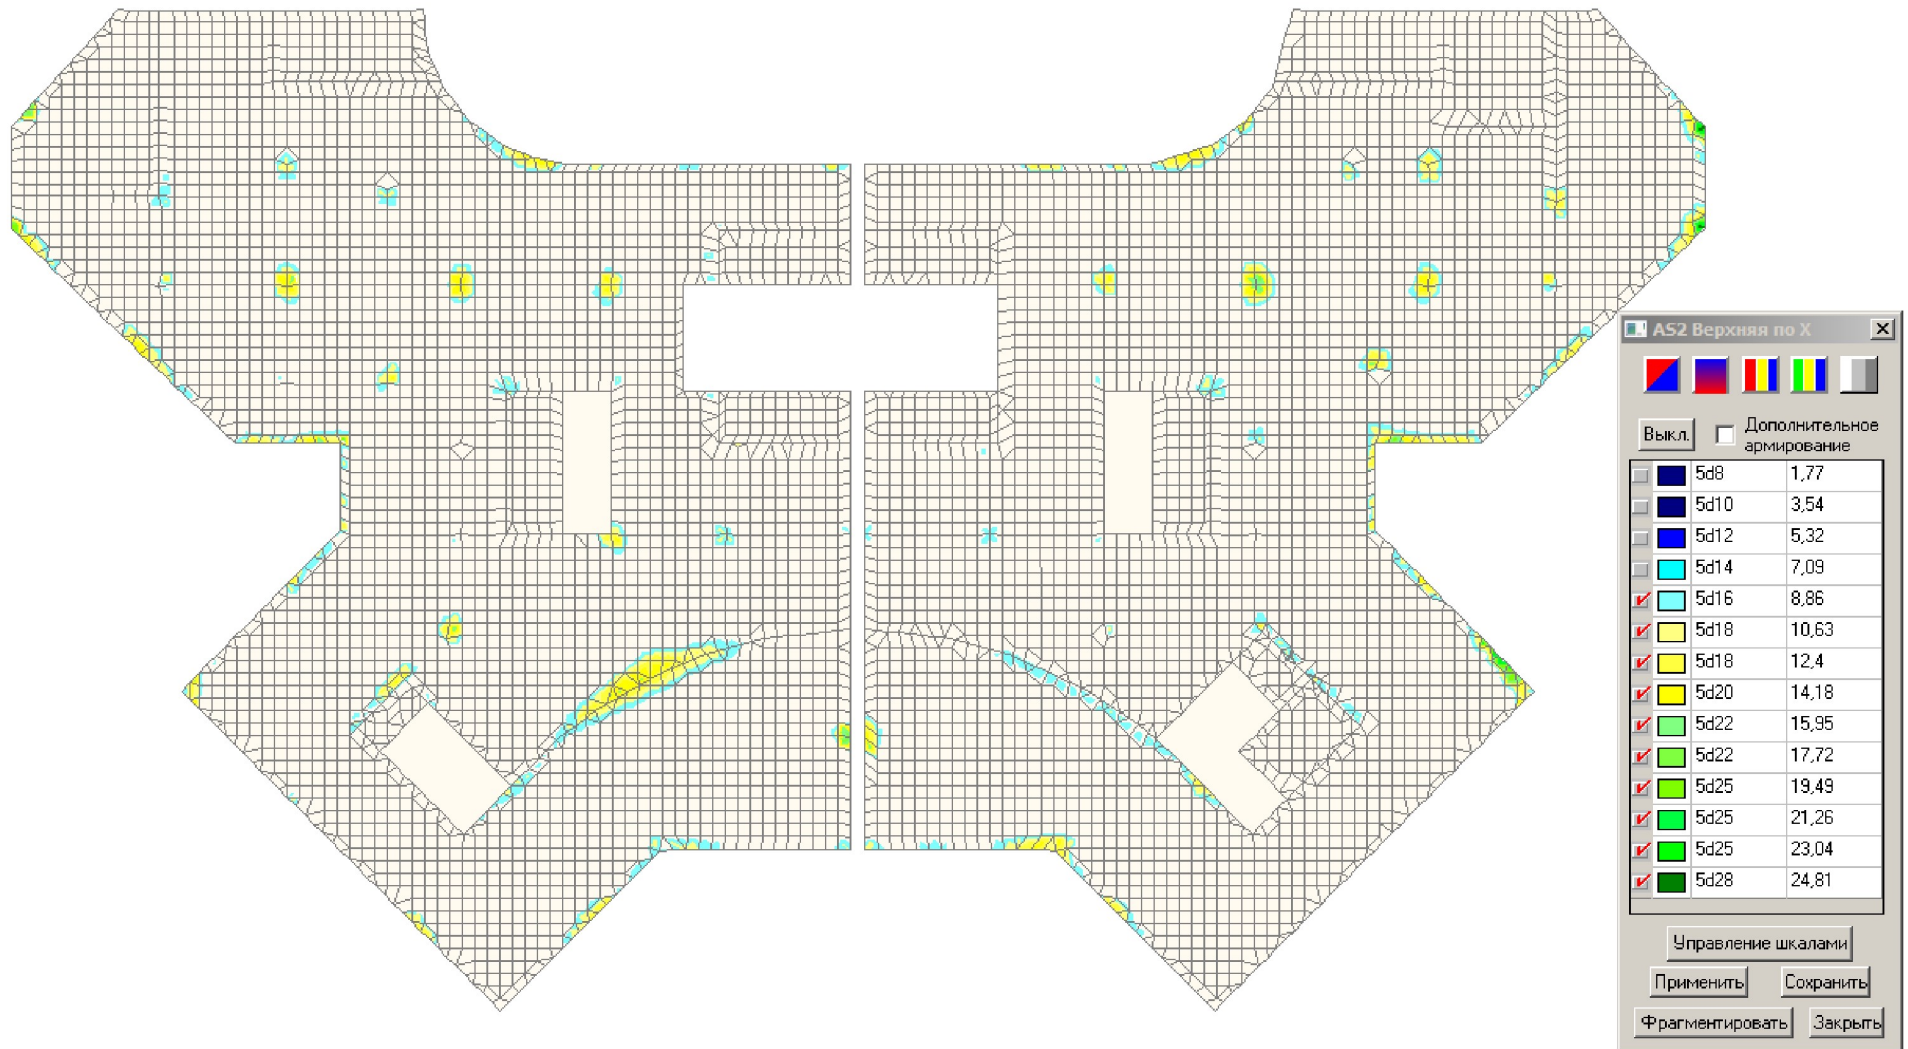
Армування плити перекриття на відм. 0.000 (верхнє X)
